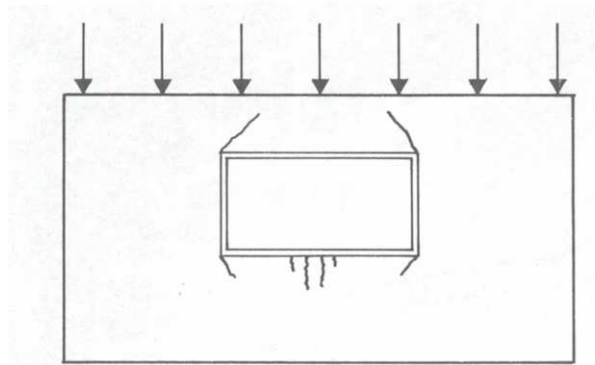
Fissuração teórica no entorno da abertura, em parede solicitada por sobrecarga vertical.
